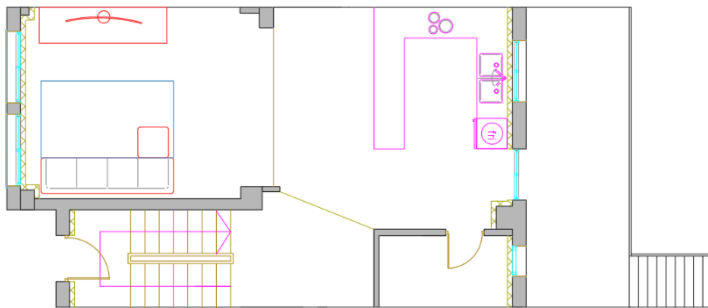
Distribución del estado reformado Pl. baja. Fuente propia
